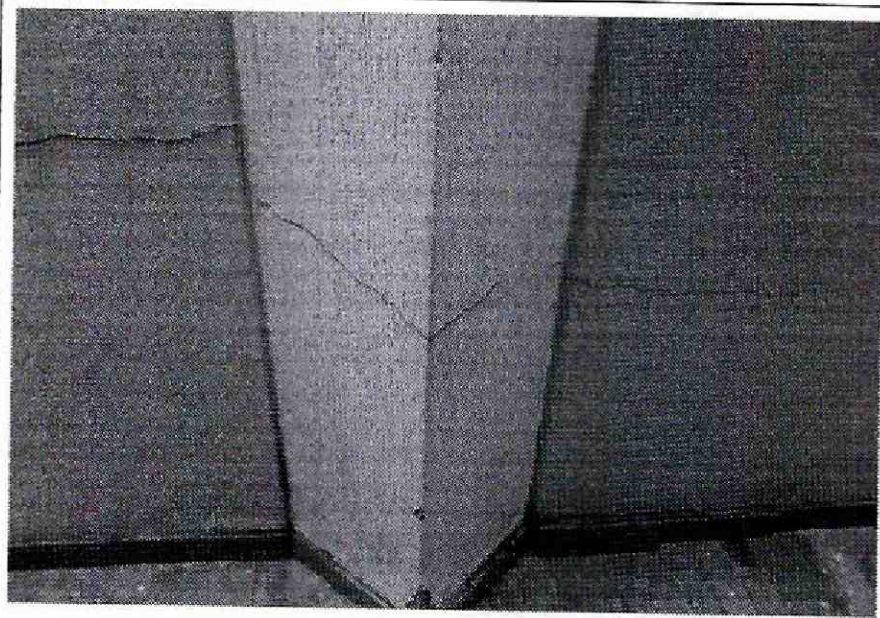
Grietas en la base del muro, afectación elemento de confinamiento.
